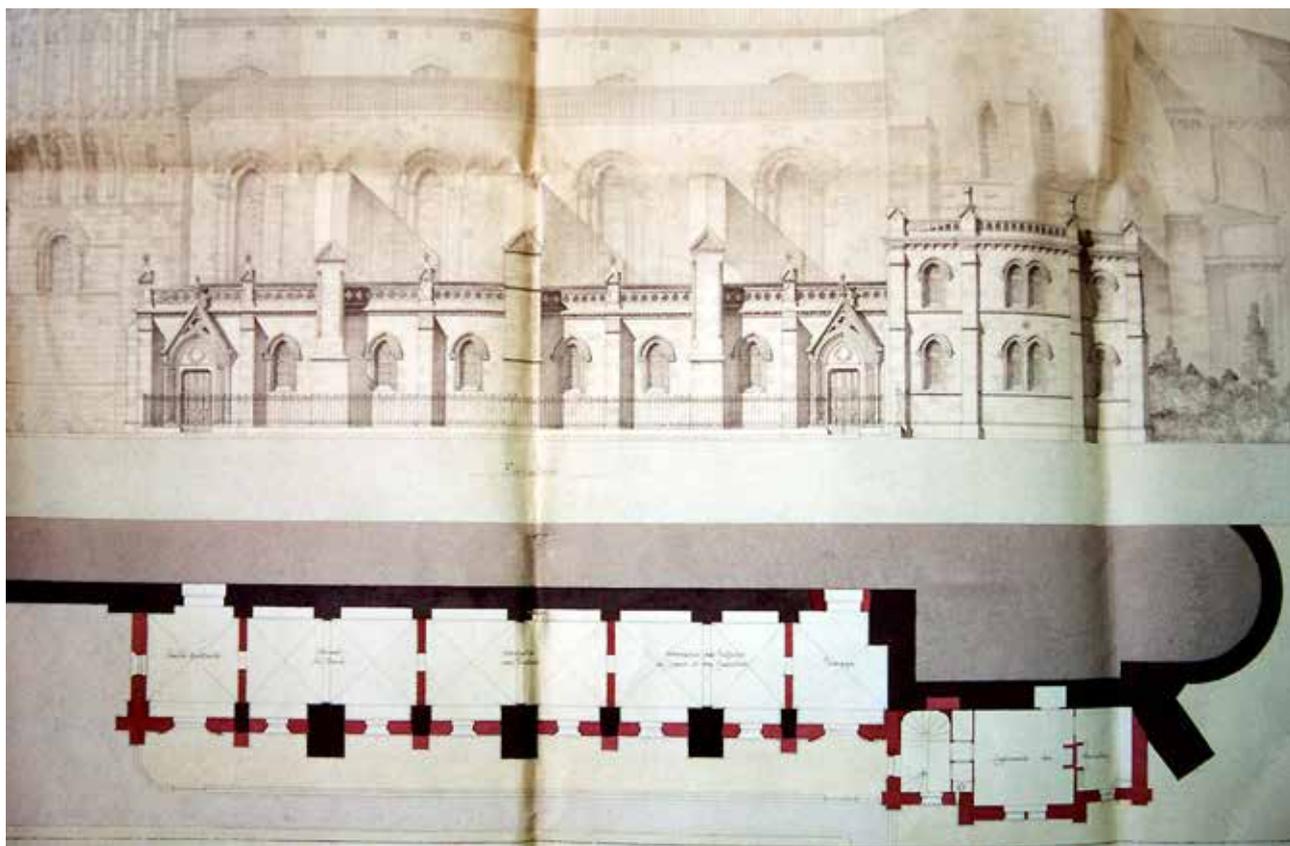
Projet de construction des sacristies par Flandrai en 1890 – Plan et élévation (A.M.Bx.).
